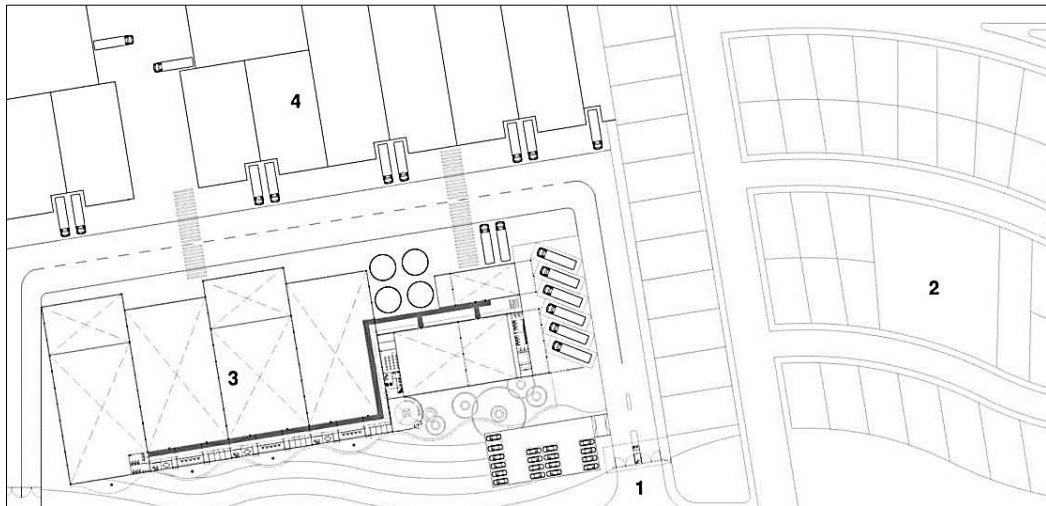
Emplazamiento del proyecto, Fuente: archdaily.pe
